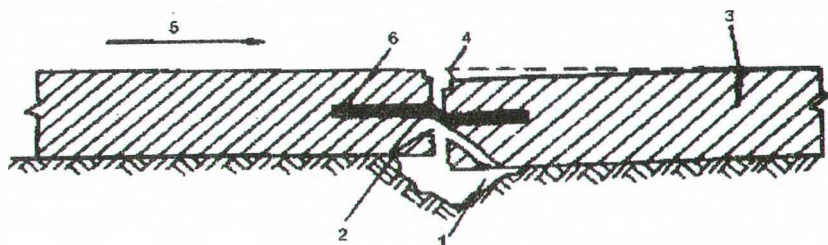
Схема разрушения бетонного покрытия в шве:
